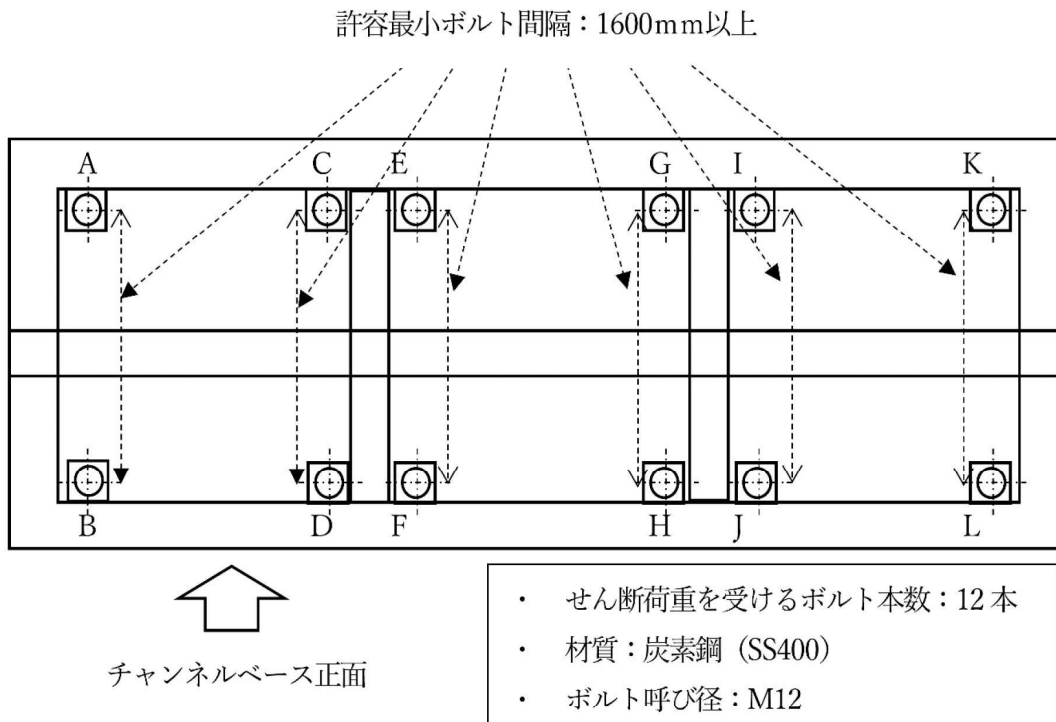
ディーゼル発電機制御盤 据付ボルト及び基礎ボルト配置図
